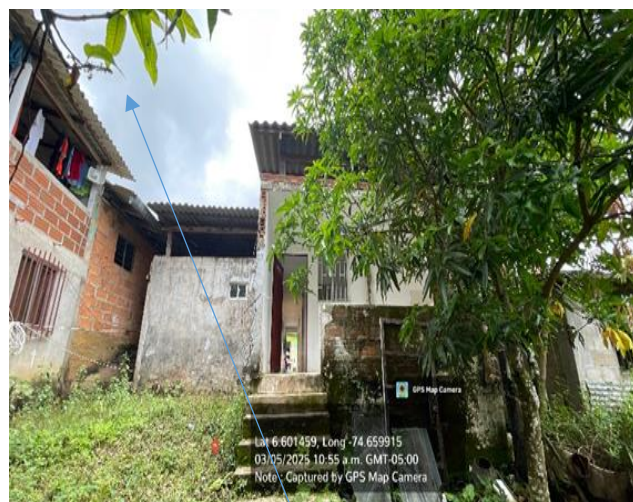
Detalle fachada posterior, se puede notar el alto grado de humedad y mal estado de la infraestructura.
